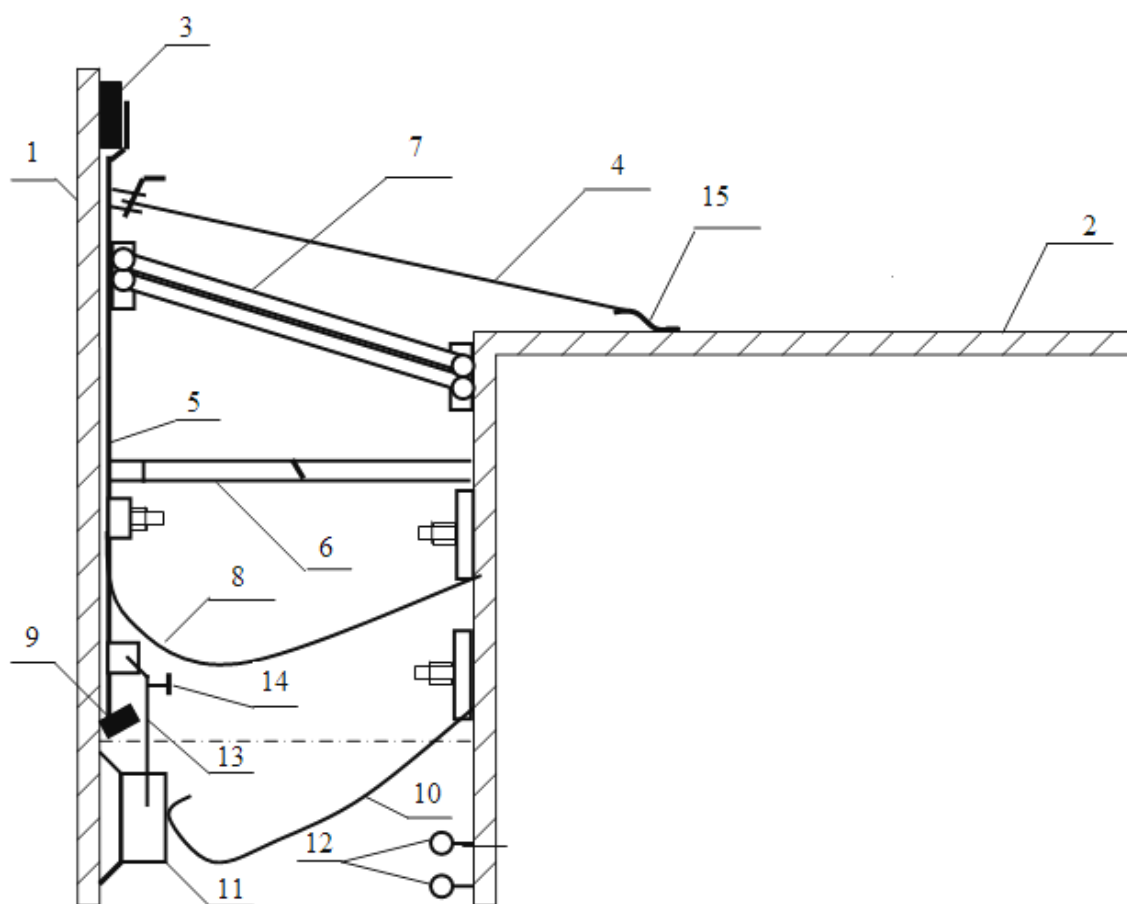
Конструкционная схема уплотняющего затвора плавающей крыши резервуара с пантографной подвеской
